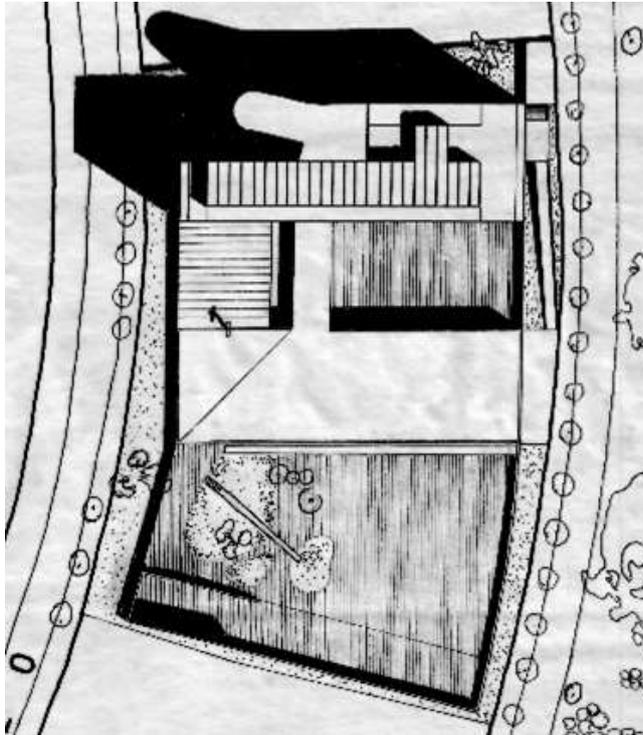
/ Fragmento del Plano Implantación 1958, DDI Imagen 18 / Planta Baja N+25.14 de 1958, A. Pereda 2024
